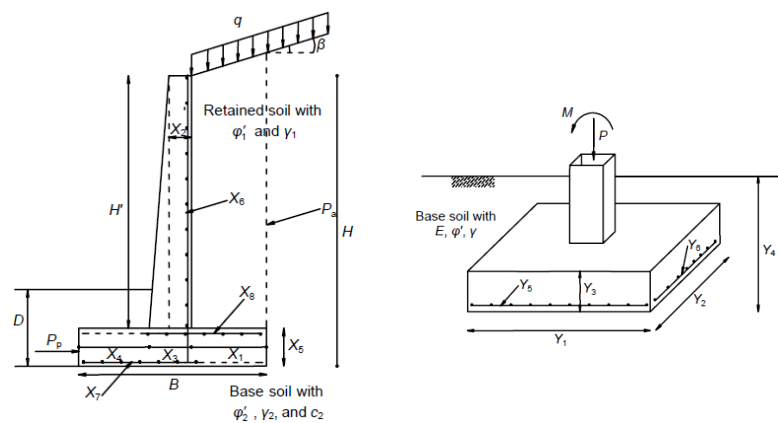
Modelo de cálculo zapata/muro contención. Khajehzadeb et al. [145].
